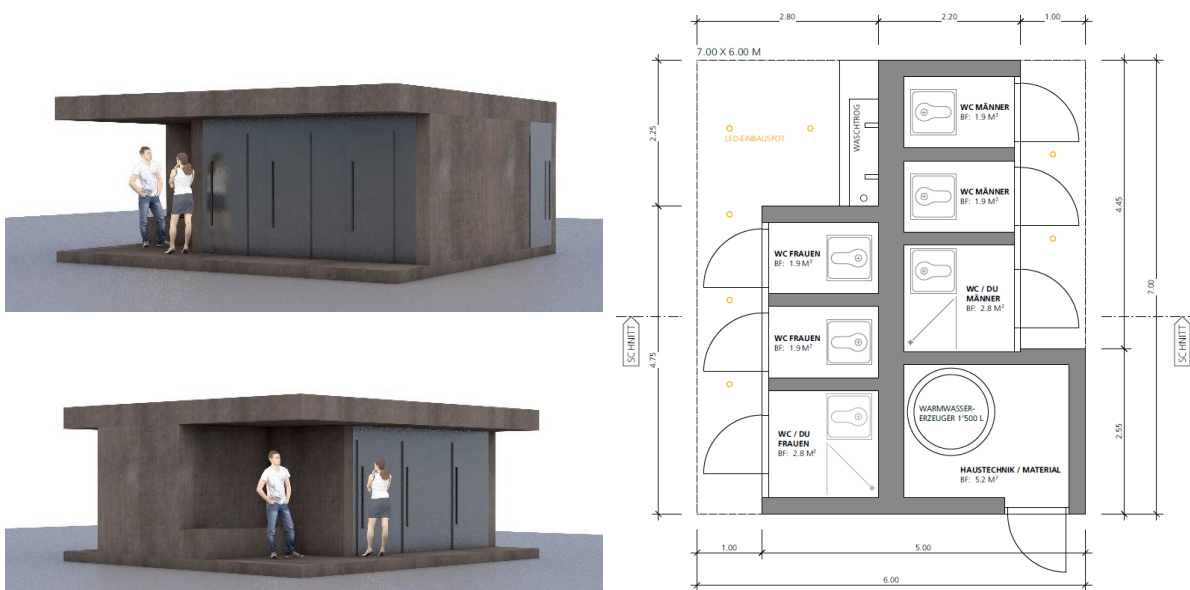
Visualisierungen und Grundriss der Sanitäranlagen
